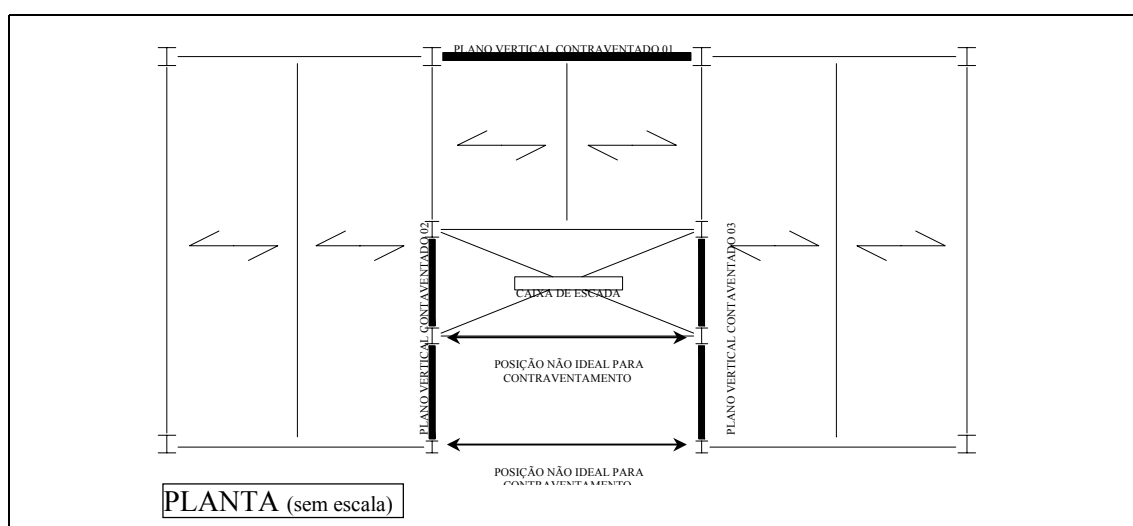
Esboço, em planta, de um lançamento estrutural não real.
